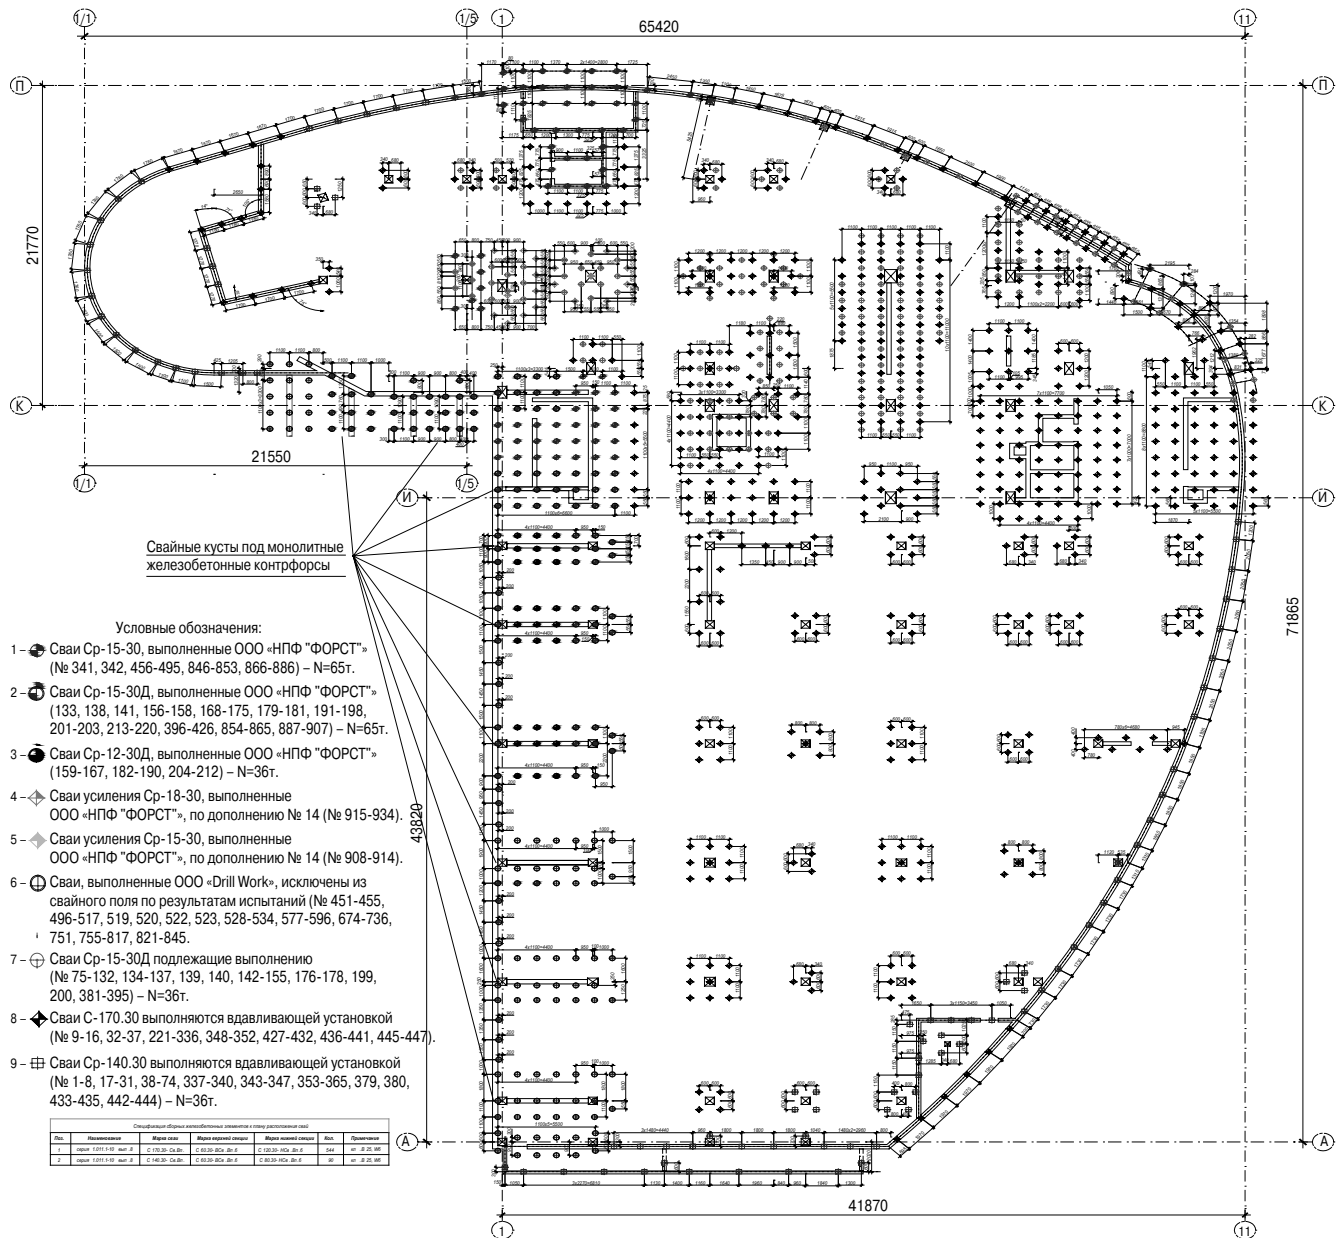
Разработанный план расположения монолитных железобетонных контрфорсов вдоль оси 1 на буринъекционных сваях, изготавливаемых по электроразрядной технологии
